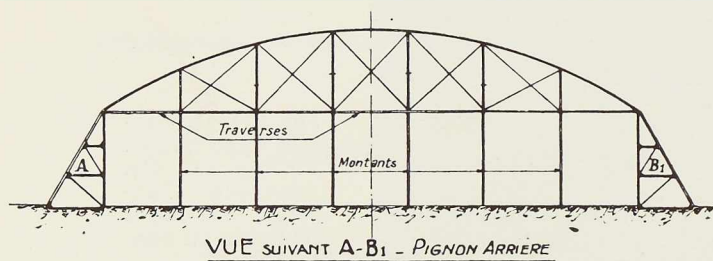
Détails constructifs d'un hangar métallique, type B. A., de 20 x 30 mètres, dont la toiture en tôle est portée par quatre poteaux d'angle.
